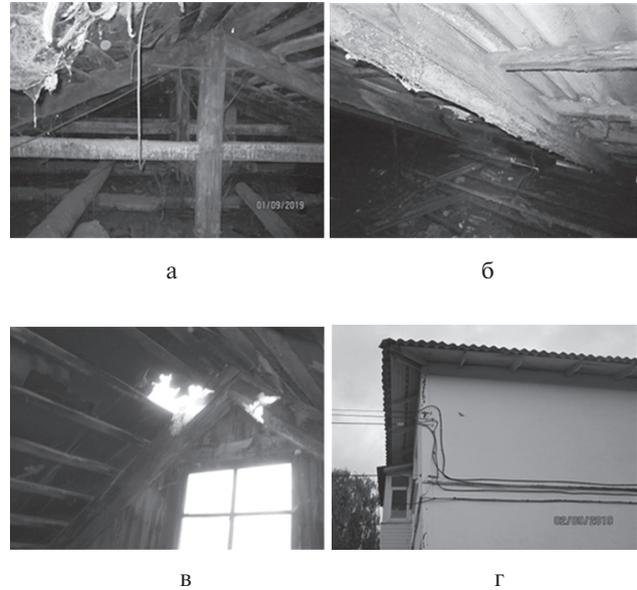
Основные дефекты стропильных конструкций и конструкций кровли:
